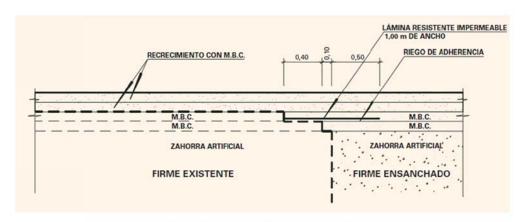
ESQUEMA DE SECCIÓN TIPO DE ENSANCHE DE FIRME
